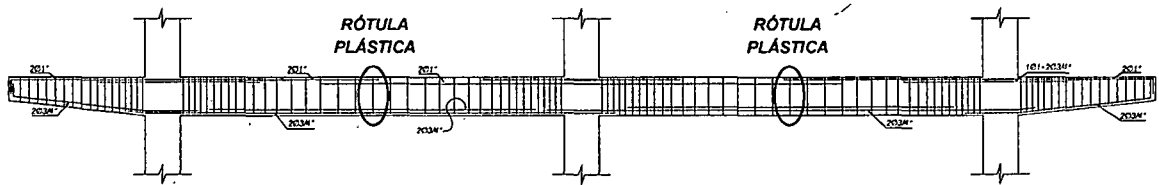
Ubicación de las rótulas a analizar en las vigas V-101, V-201, V-102 y V-202
